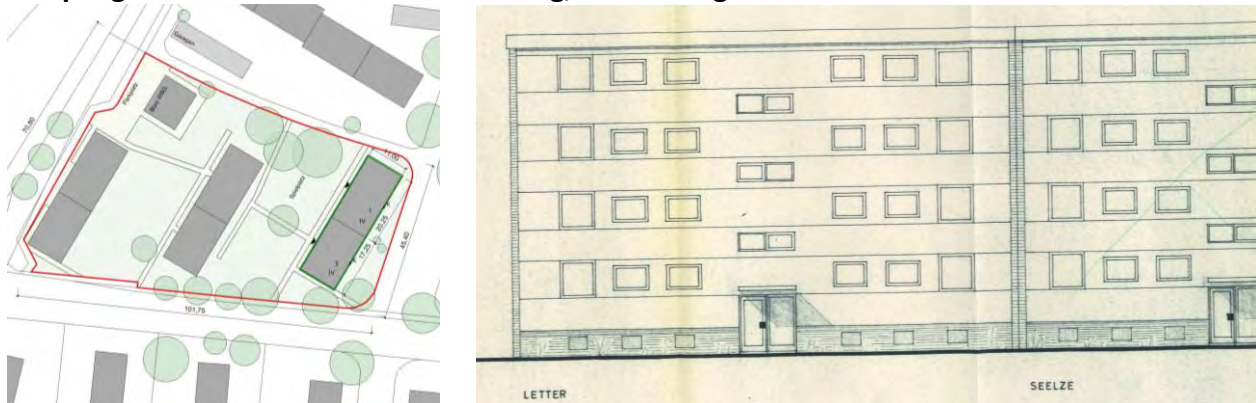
Lageplan und Straßenansicht. Quelle: Eigene Darstellung / Ansicht Originalplan
